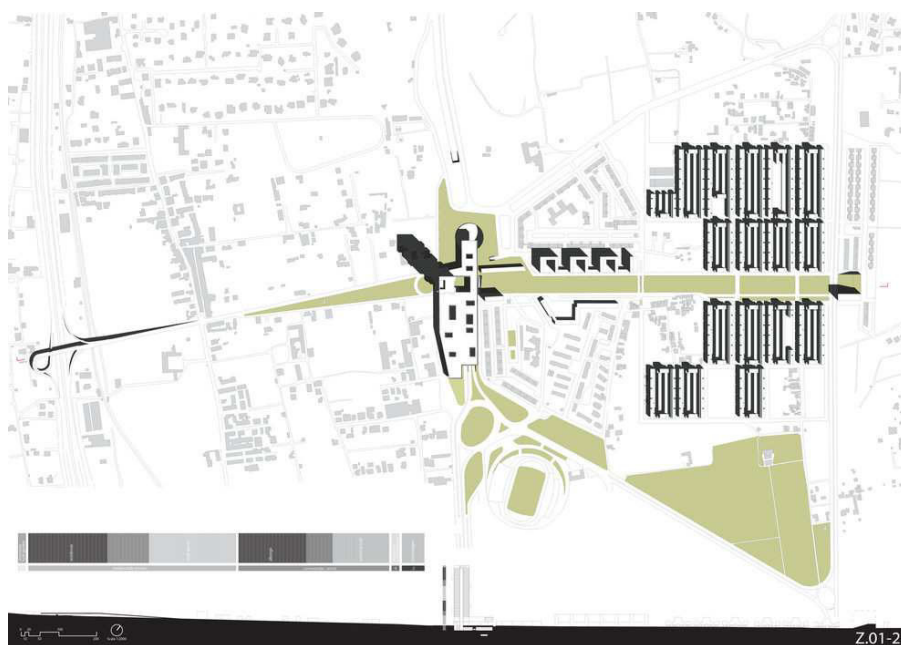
Masterplan di progetto dell'intervento allo Zen 2
